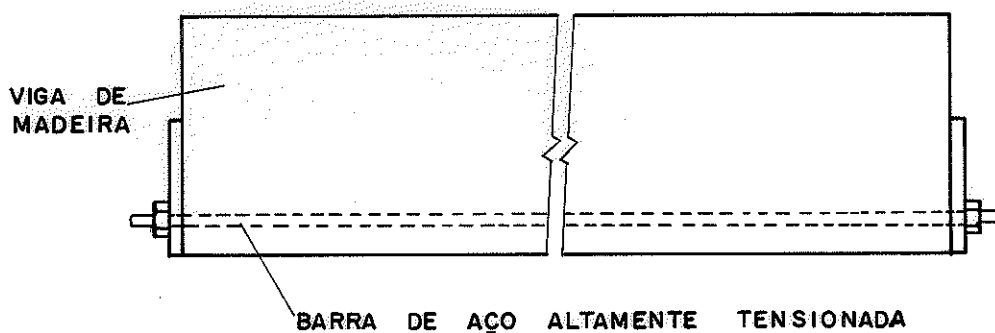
VIGA DE MADEIRA LAMINADA PROTENDIDA
